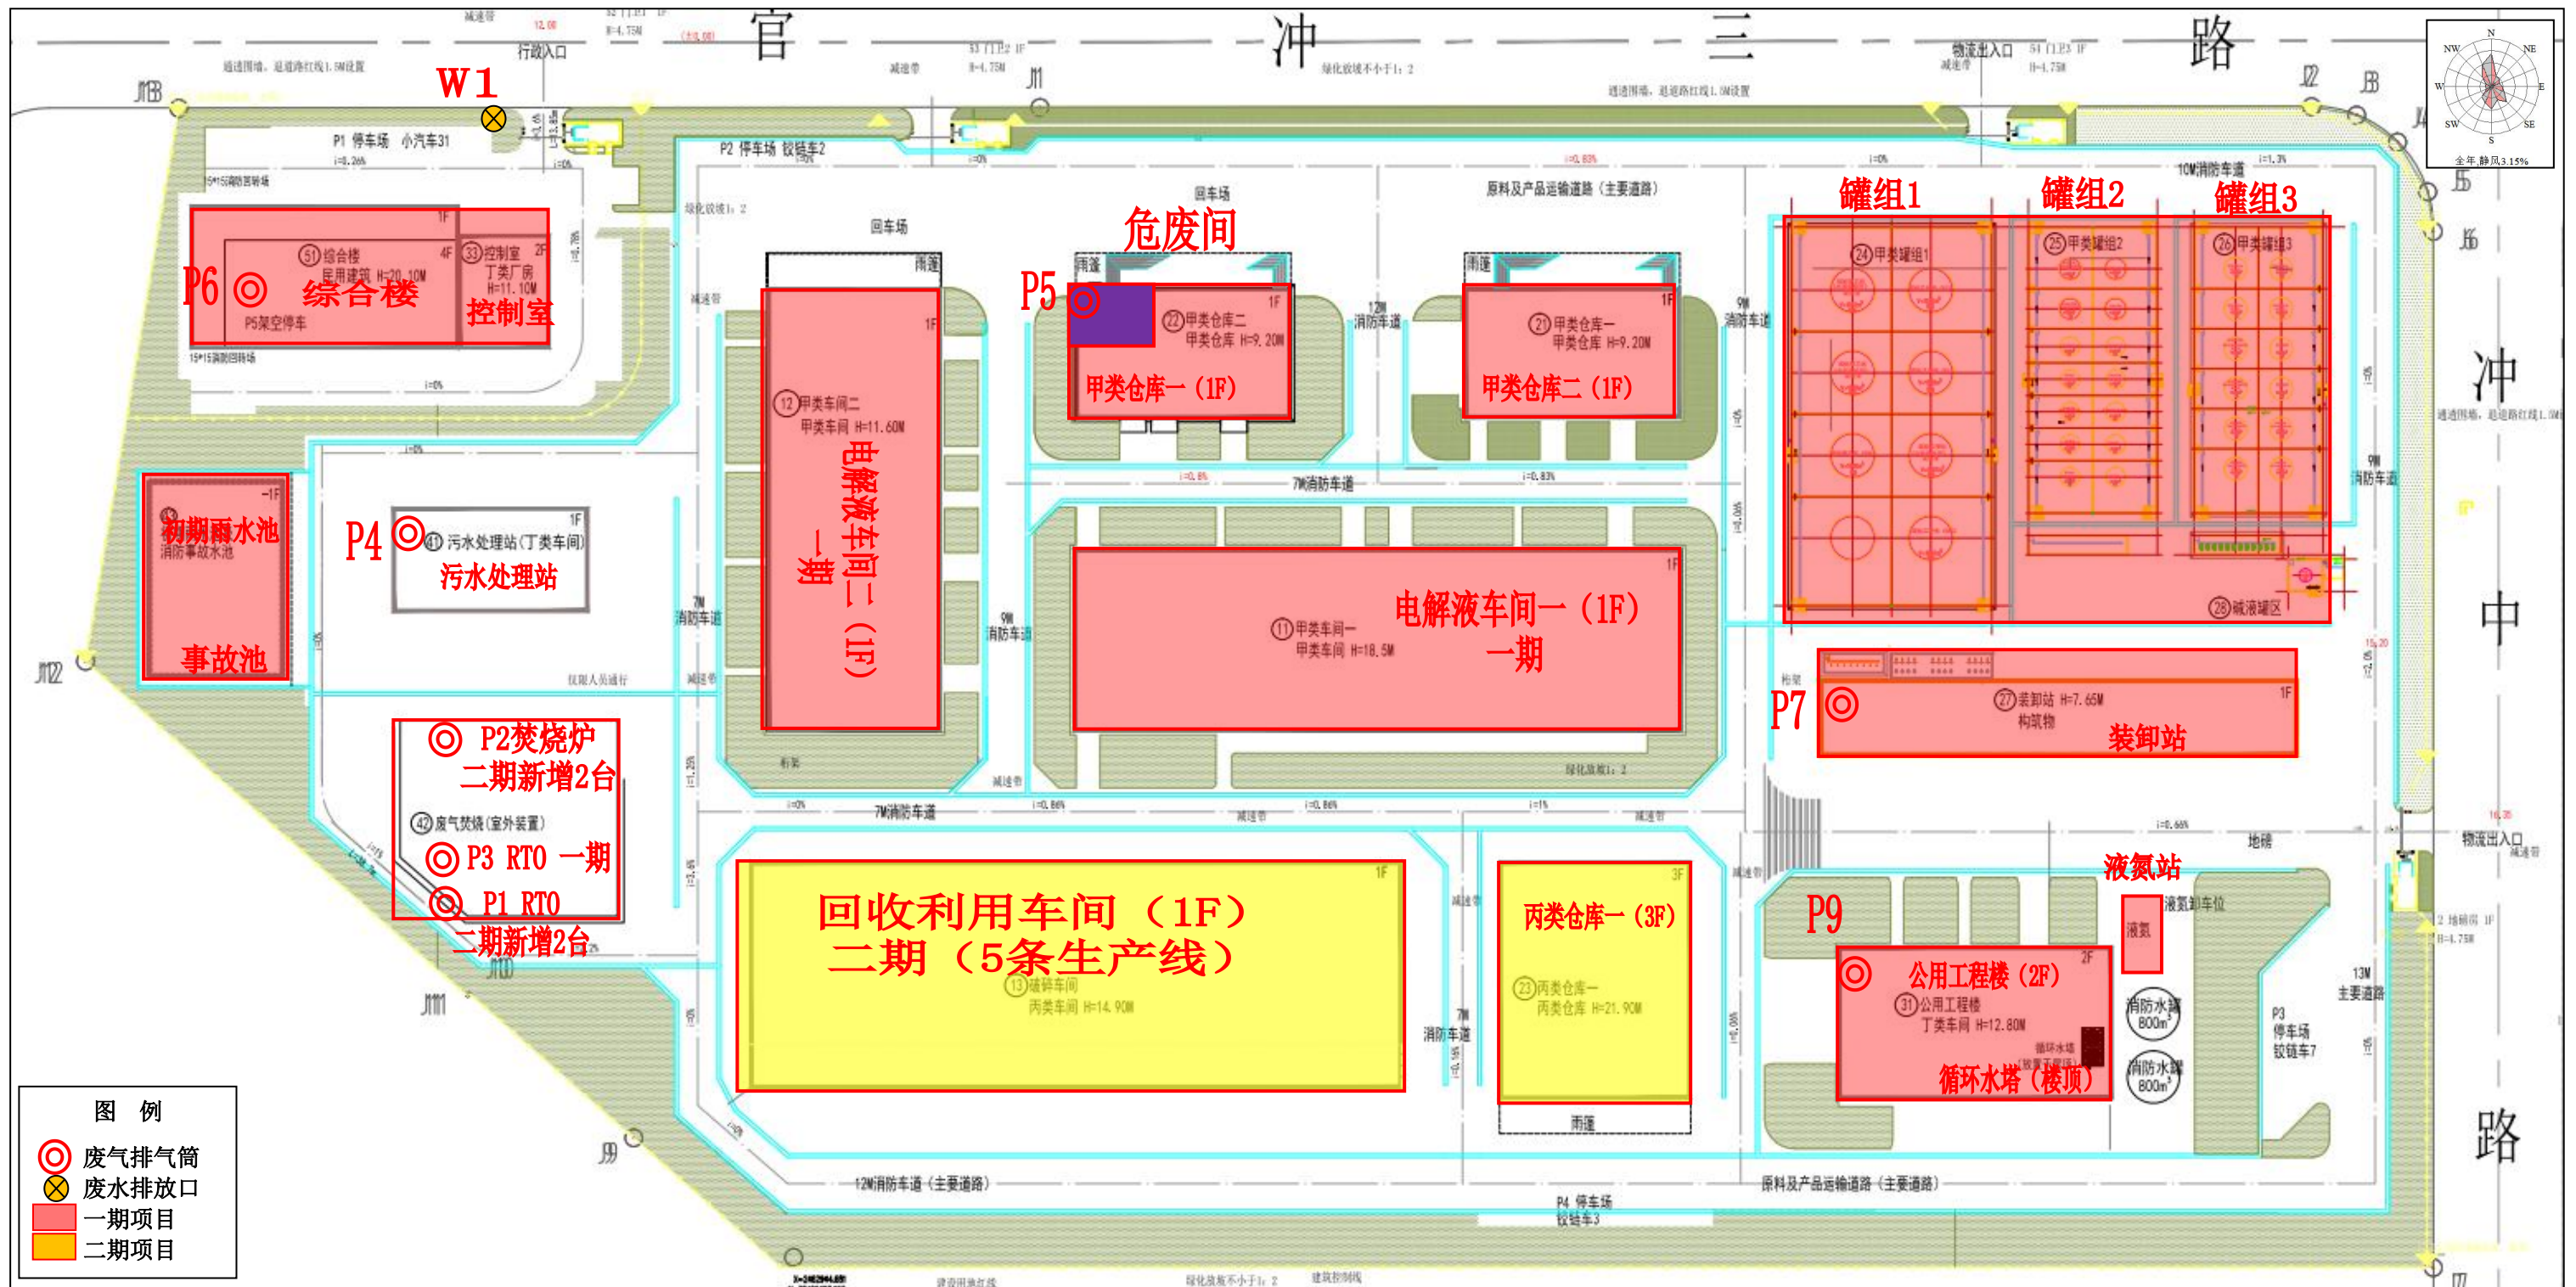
总体项目平面布置图 (比例尺1:1000)
